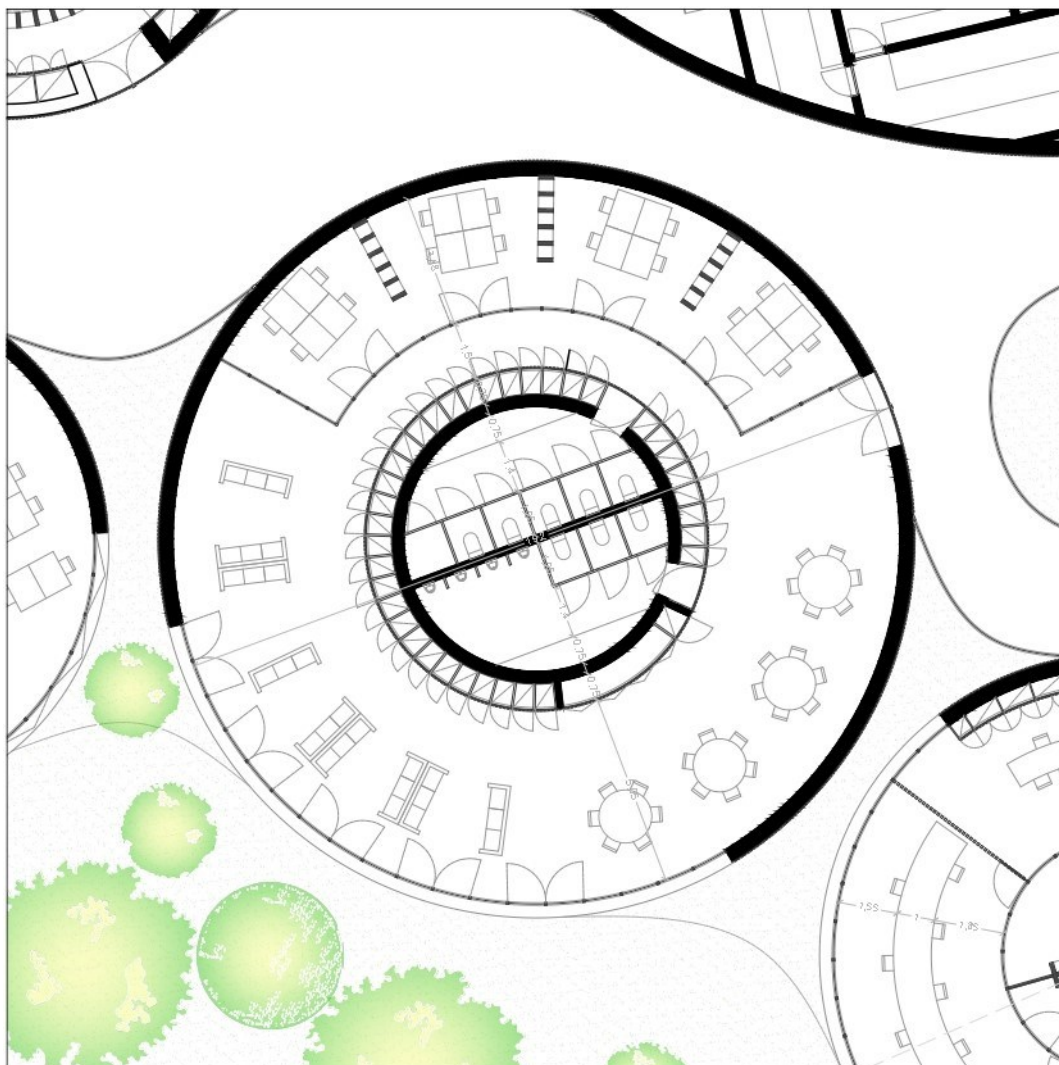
Planta de Piso Térreo, com Localização do Núcleo de Pessoal Docente e Não Docente
